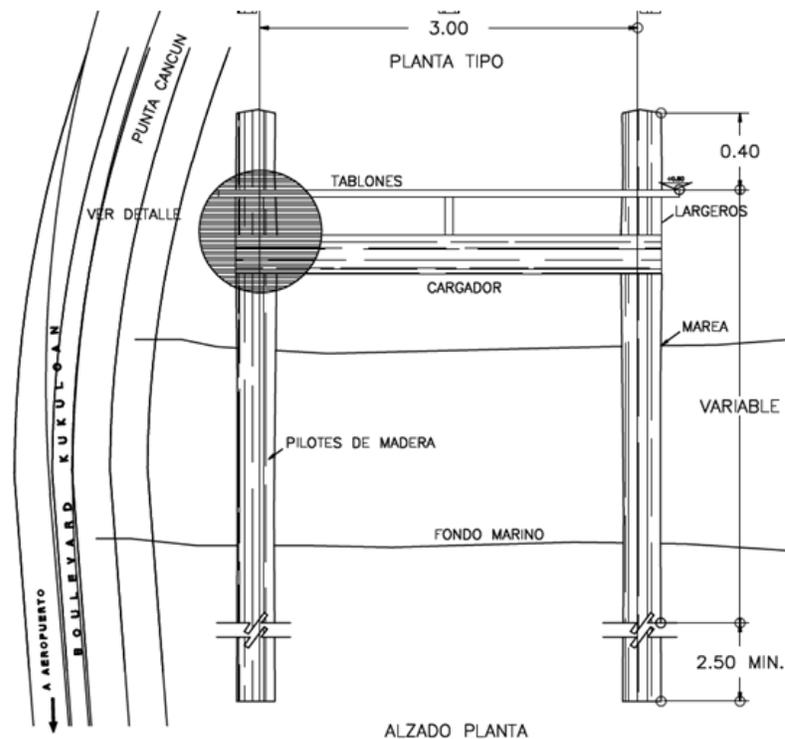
Detalle constructivo de los pilotes de madera de la Marina Flamingo
